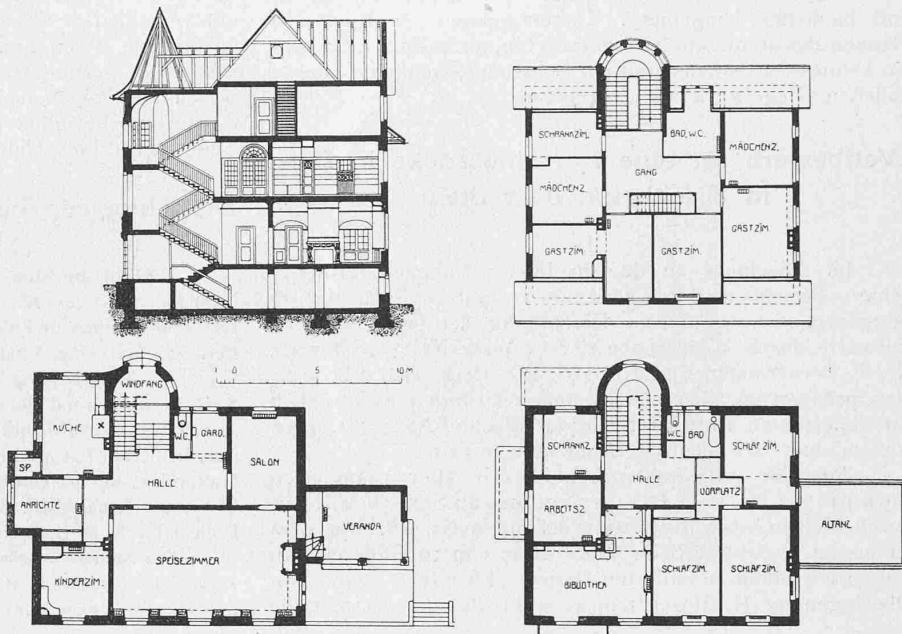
bis 5. Grundrisse und Schnitt des Hauses Dr. Jung. — Masstab 1:400.
